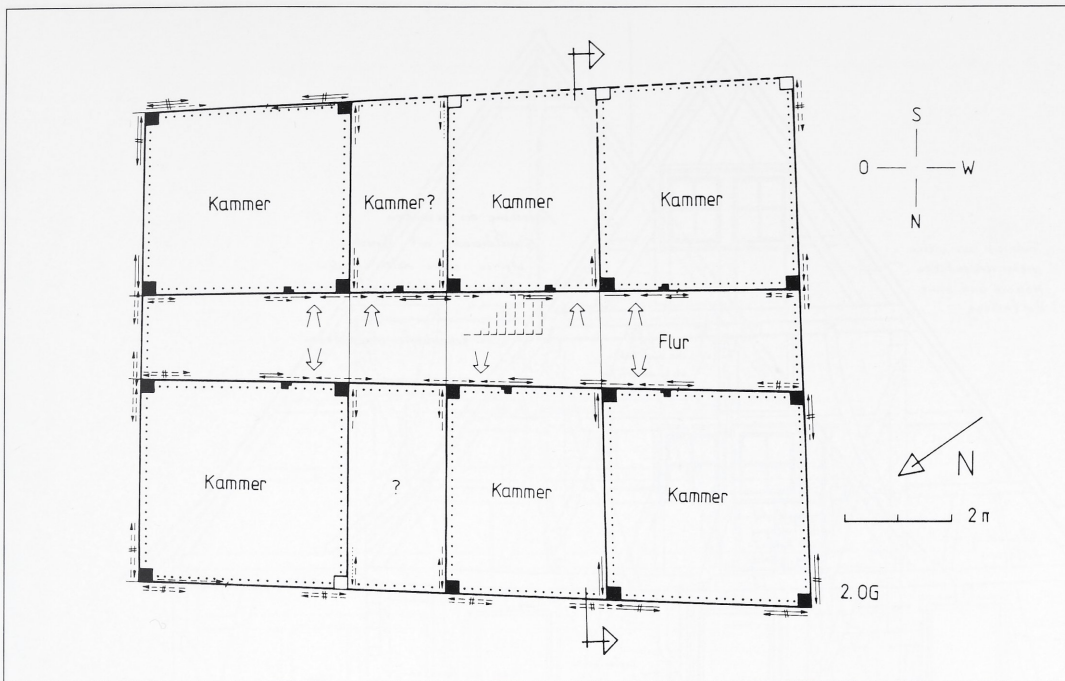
Meßkirch, Hauptstraße 27. Rekonstruktion der ursprünglichen Grundrißgliederung des zweiten Obergeschosses.
